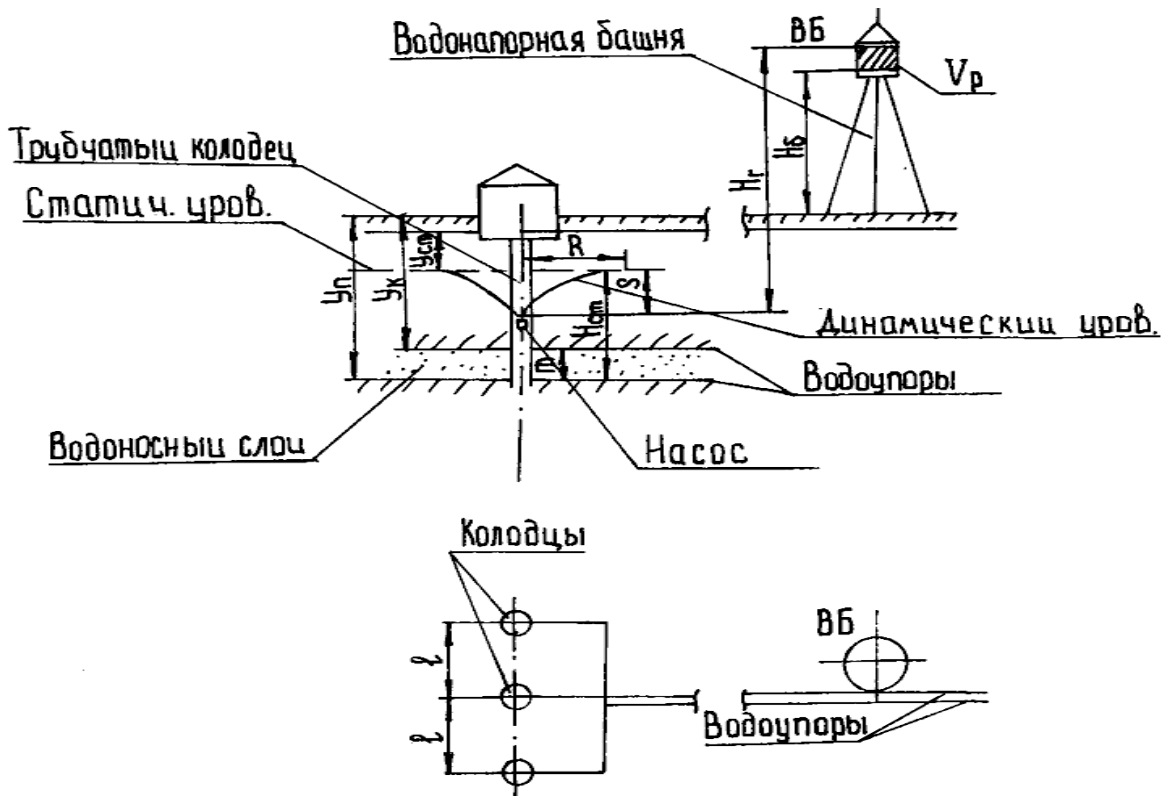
Расчётная схема водозаборного и напорно-регулирующего сооружений:
